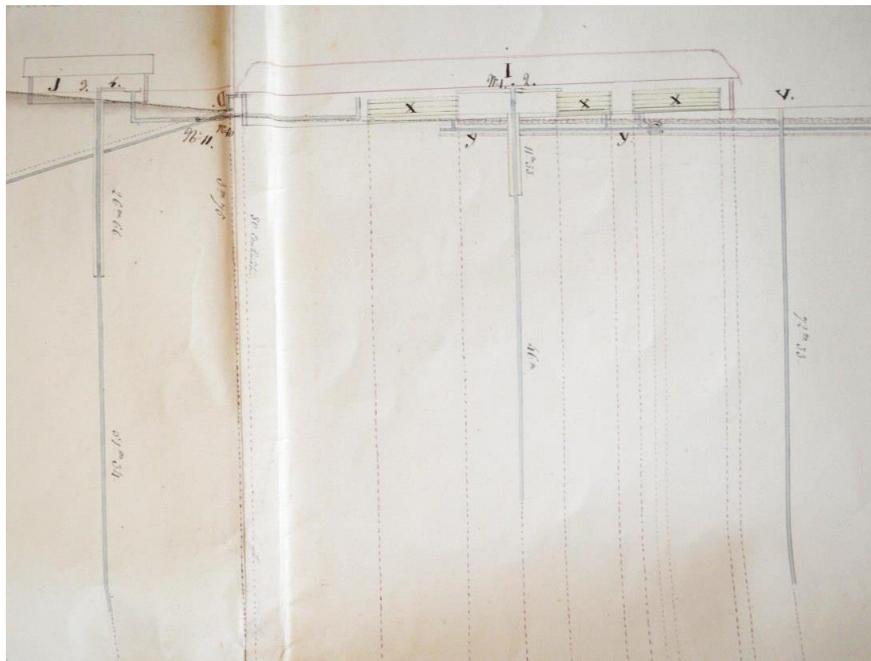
Extrait d'un plan datant de 1842 (AD70 – 299 S10) – coupe verticale E-W
